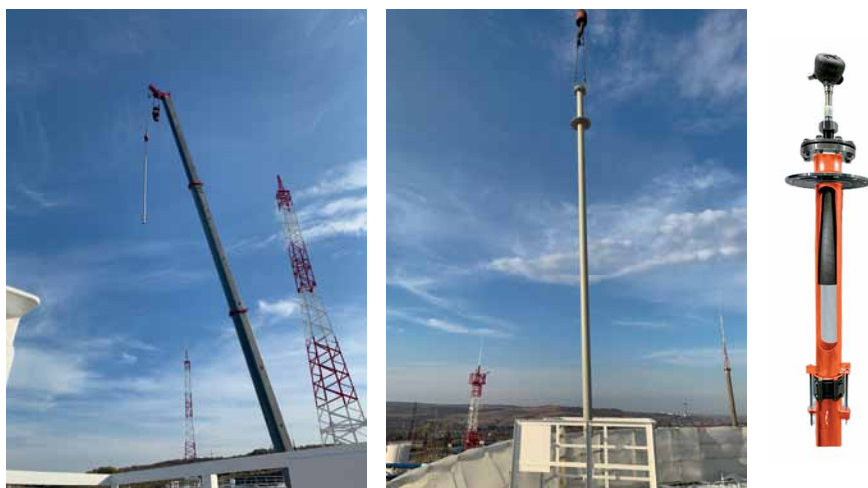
Установка измерительной трубы радиоволнового измерителя уровня РДУЗ-40 на резервуар с помощью крана-манипулятора
